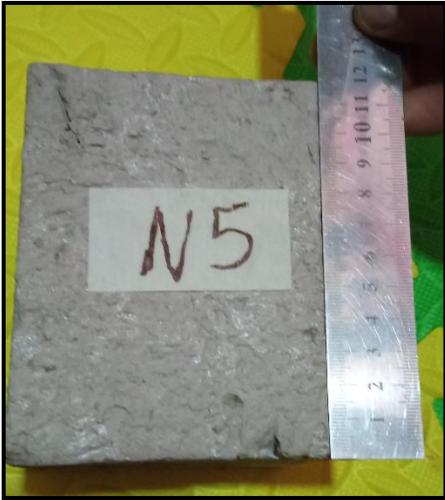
Dimensionamiento de cada muestra con regla milimétrica.
